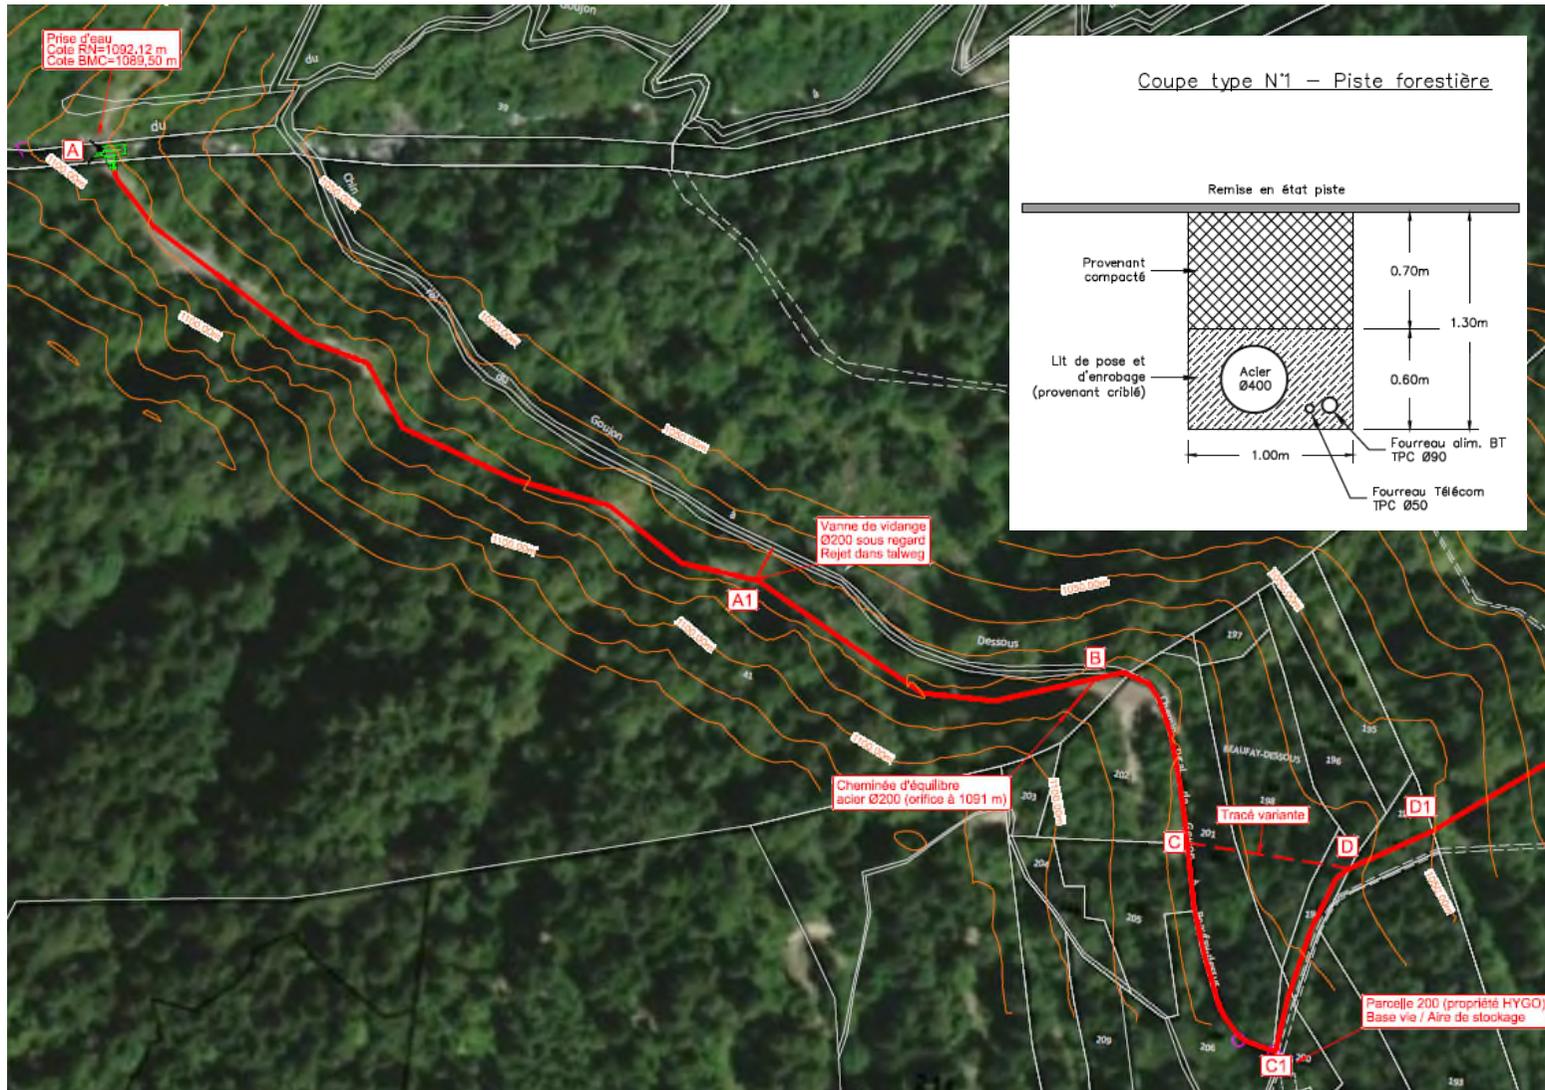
Pose de la conduite forcée sur le tronçon ABCC1
